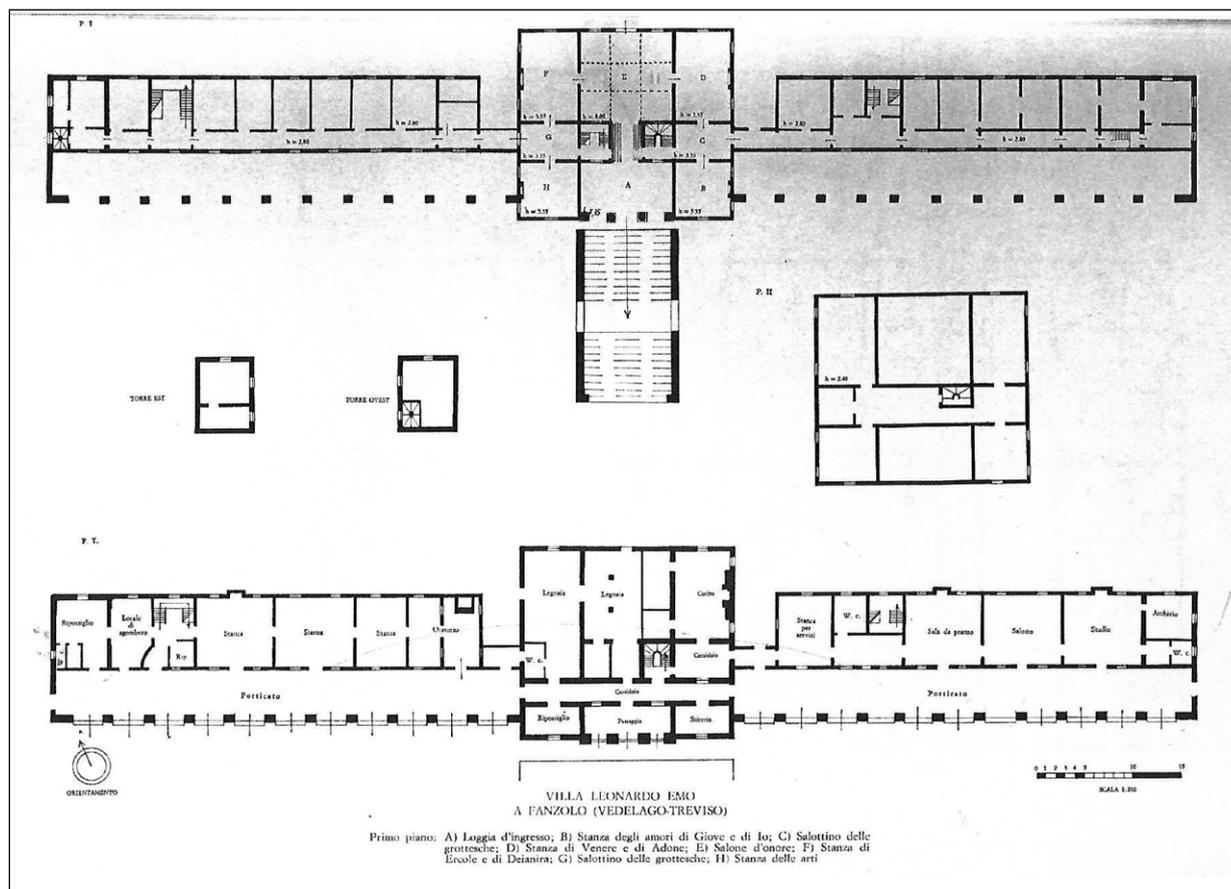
Plantas baixas do projeto executado da villa Emo. Fonte: Zorzi, 1969.
